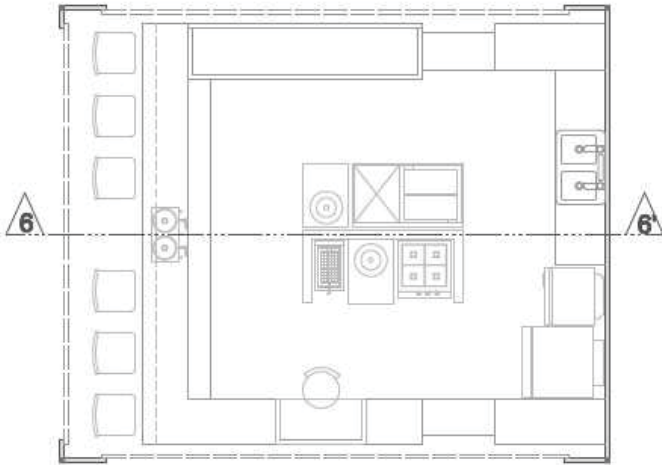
Boxes de 30m<sup>2</sup> (alimentício) – Layout e corte
